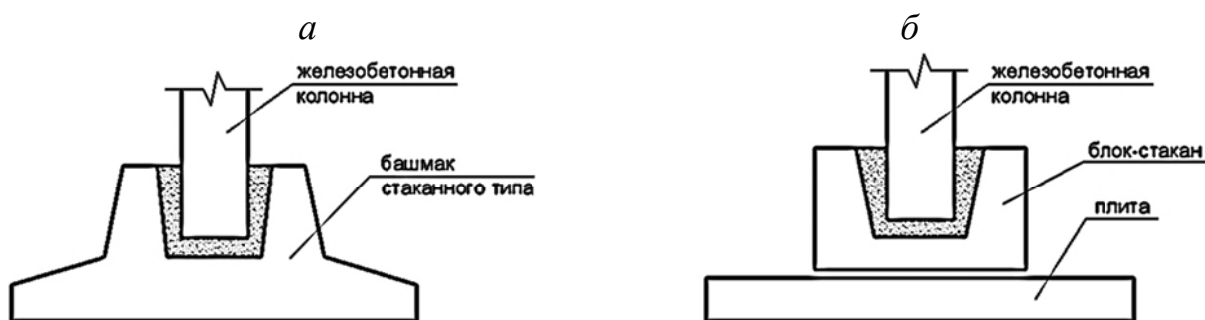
Столбчатые фундаменты под железобетонную колонну: а – монолитный; б – сборный из железобетонных блоков-подушек
